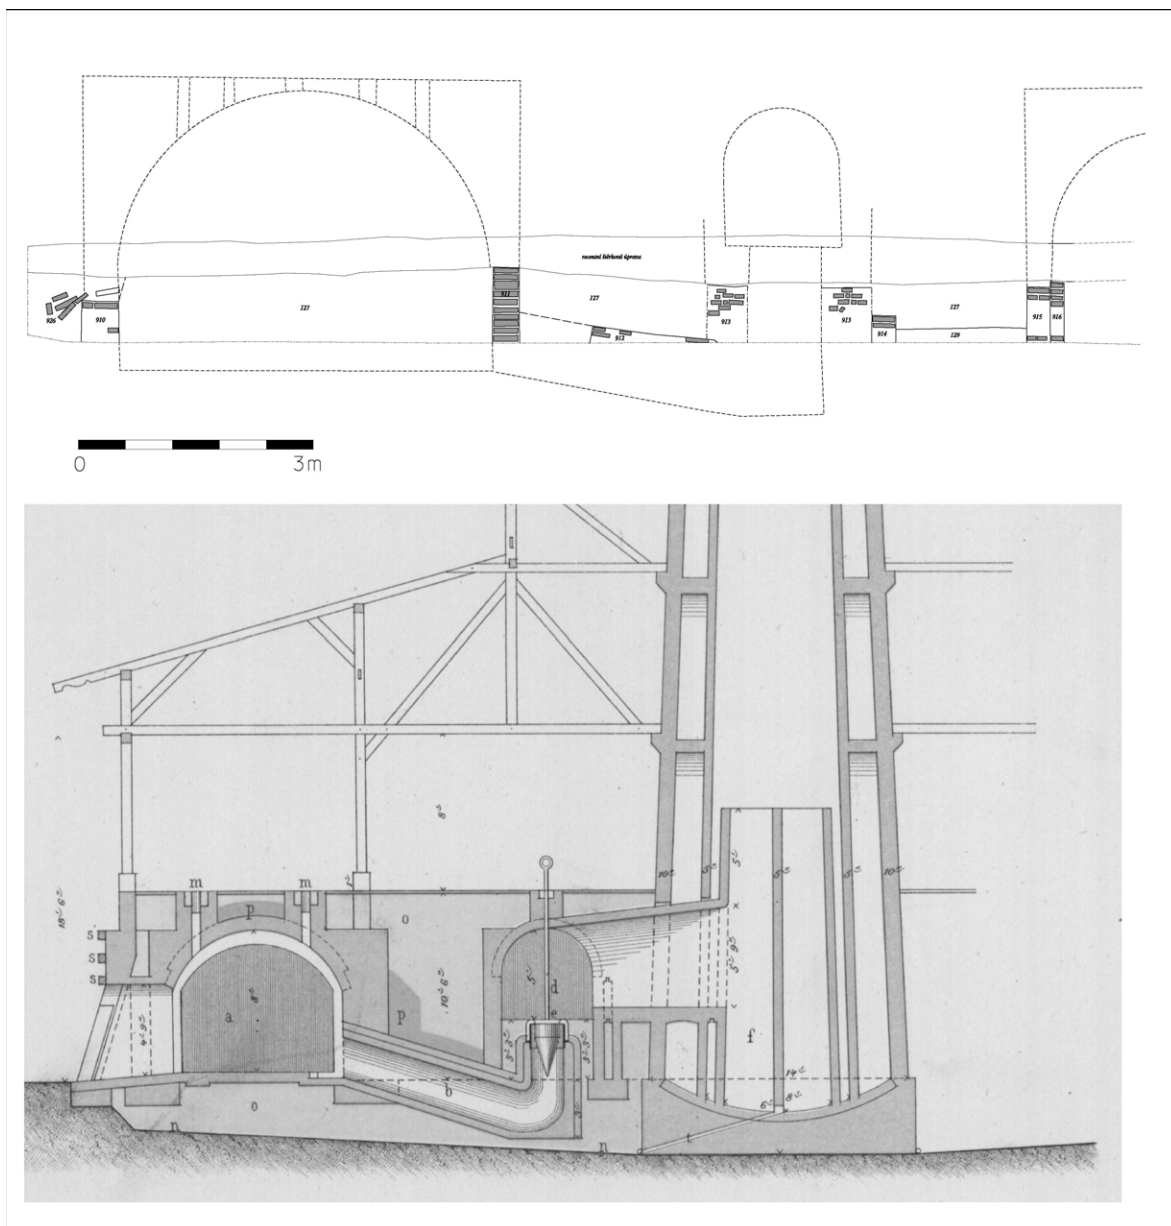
Částečně rekonstruovaný půdorys pece a zachycení řezů
